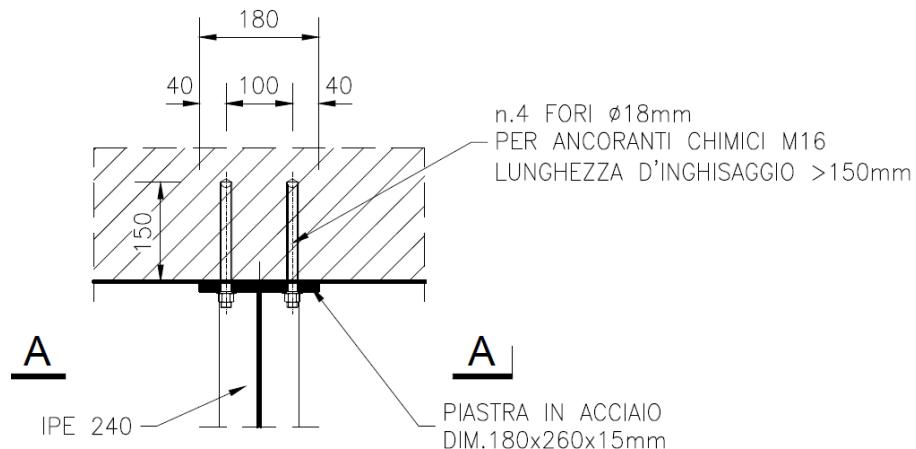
Pianta della connessione IPE240 - "Particolare 2"
